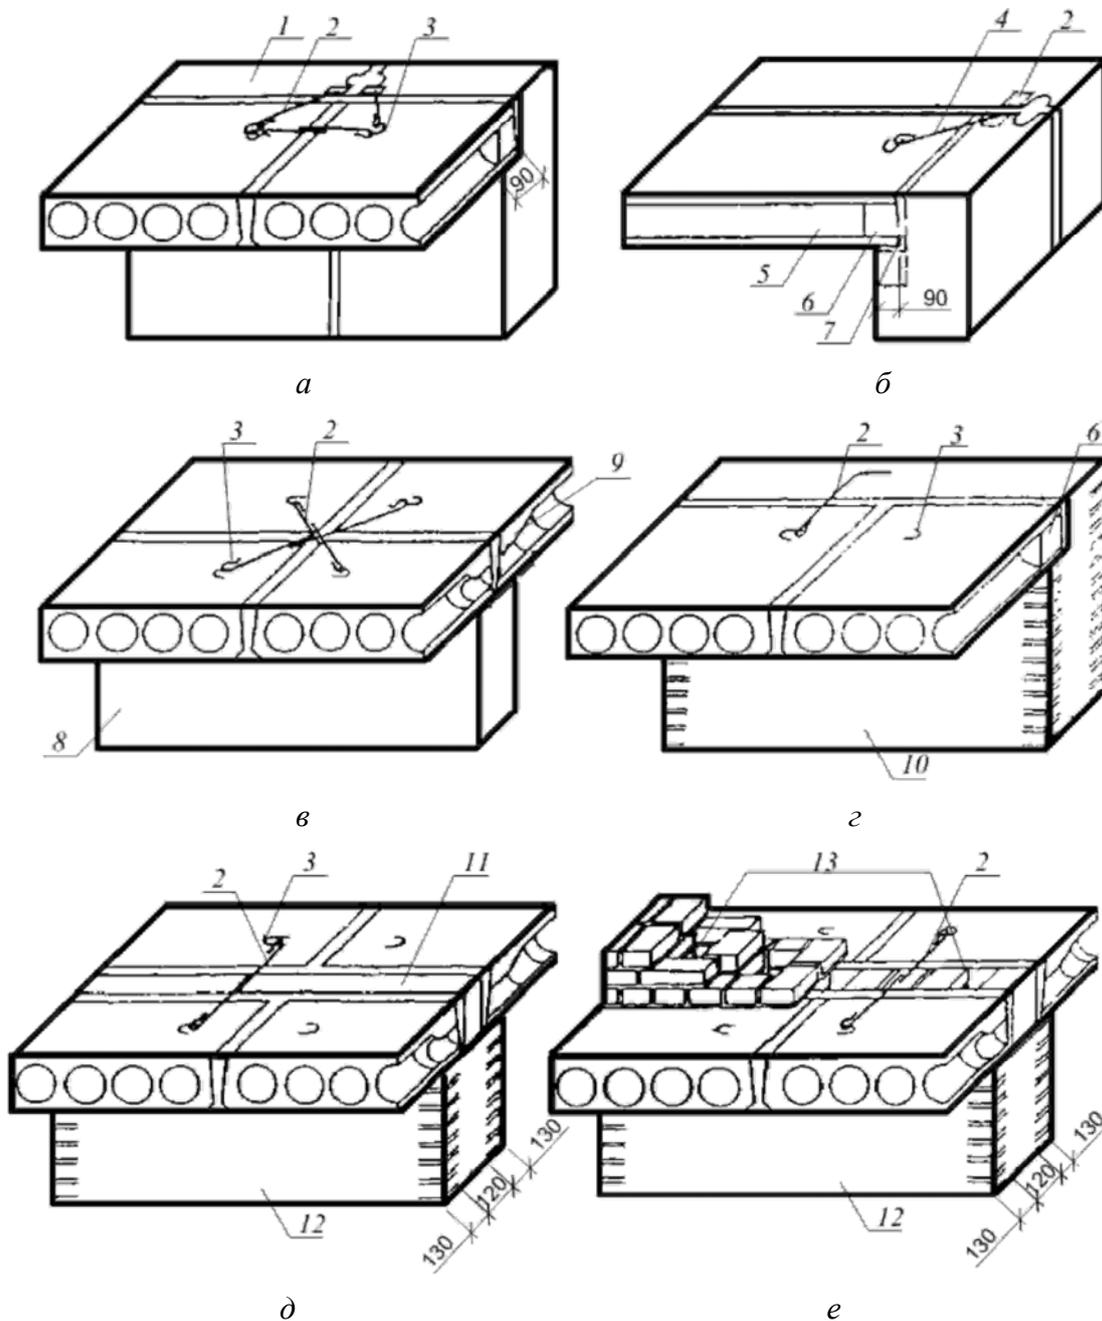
Фрагменты опирания многопустотных панелей перекрытия на стены: *а, б* — наружные крупноблочные стены; *в* — внутренние крупноблочные стены; *г* — наружные кирпичные; *д* — внутренние кирпичные; *е* — то же с каналами: 1 — крупный блок наружной стены; 2 — анкер; 3 — подъемная петля; 4 — закладная деталь; 5 — многопустотная панель; 6 — заглушка пустоты; 7 — минераловатная плита; 8 — блок внутренней стены; 9 — усиленный торец панели; 10 — наружная стена; 11 — бетонный брусок; 12 — внутренняя стена; 13 — каналы
